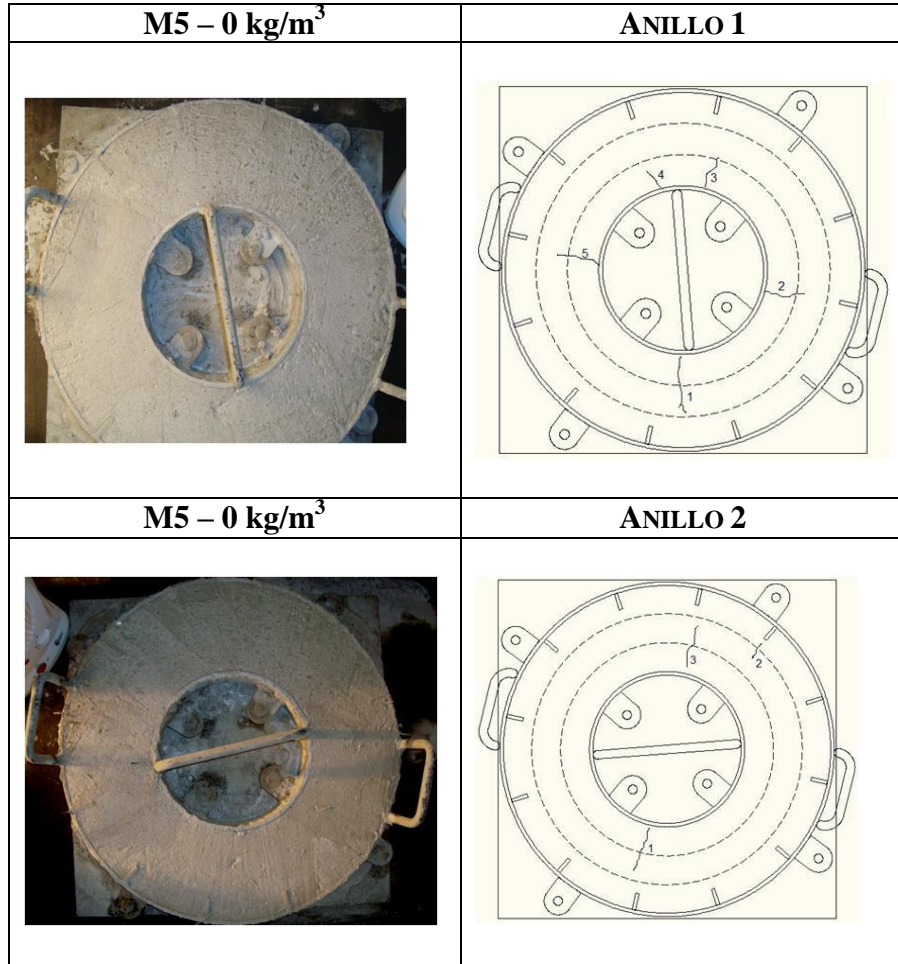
Grietas de Contracción Plástica de la Mezcla 5
